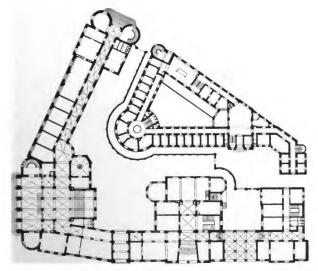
Gerichtsgebäude. Grundrifs des Erdgeschosses.
